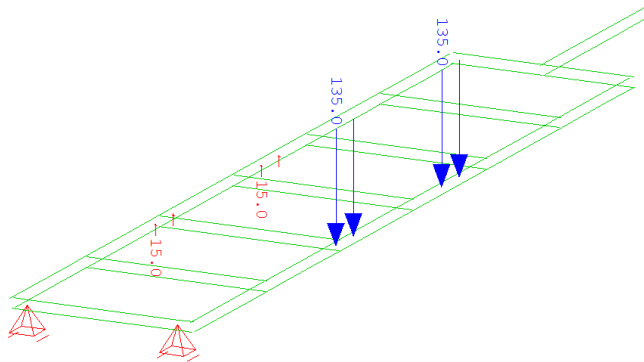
Cargas aplicadas na zona bi-viga.
